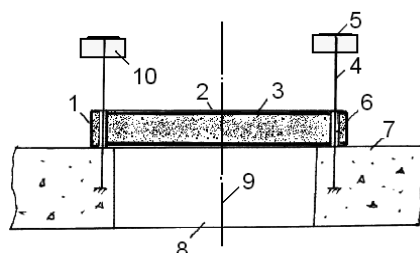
Схема взрывозащитной плиты покрытия (или кровли) взрывоопасного объекта
